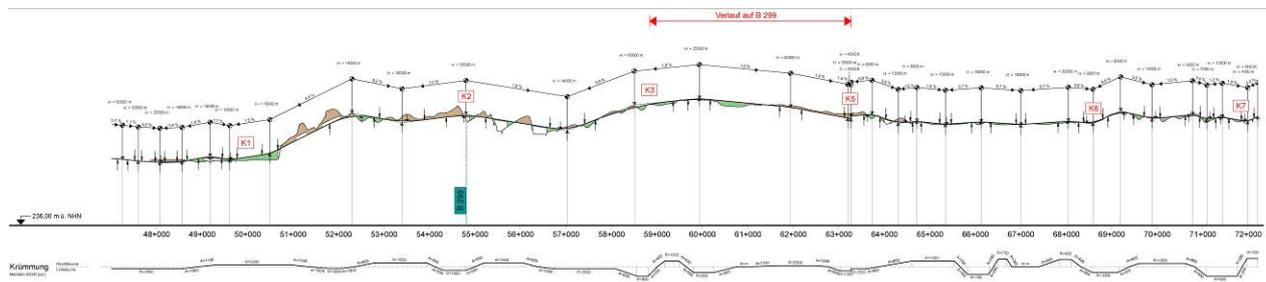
Höhenplan Planfall 1b (Unterlage 4, Blatt 2)
